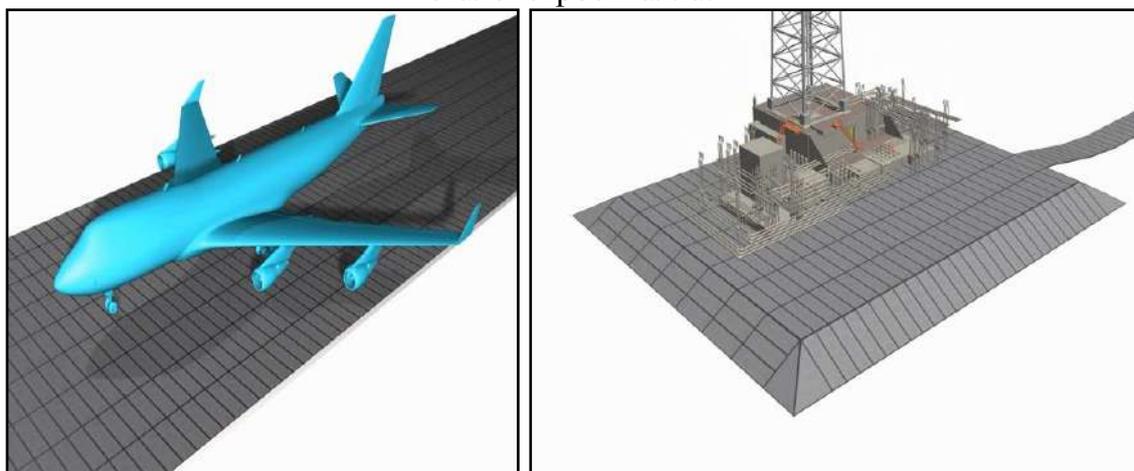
Взлетно-посадочная полоса (слева) и буровая площадка (справа) на основе свайно-эстакадной конструкции с покрытием сталепетроситалловыми плитами
